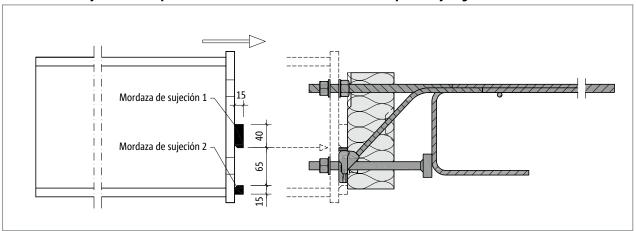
Schöck Isokorb® T tipo SK: Montaje de la viga de acero
